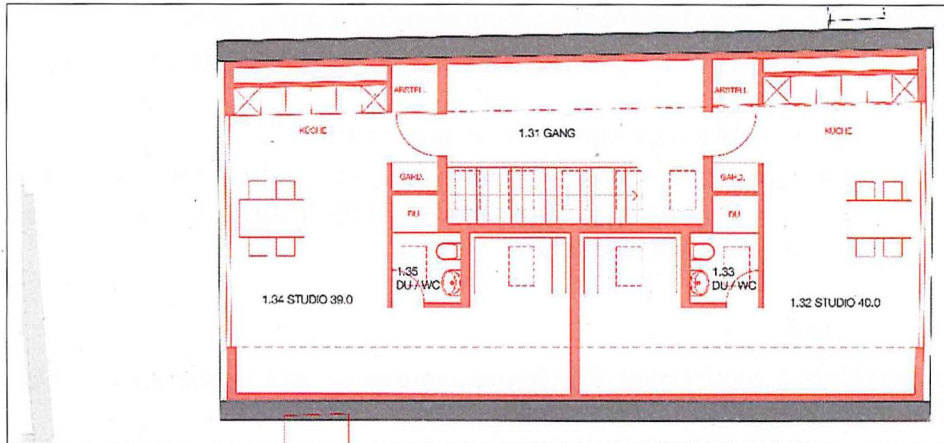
Grundriss Remise, 1. Obergeschoss mit zwei Studios
